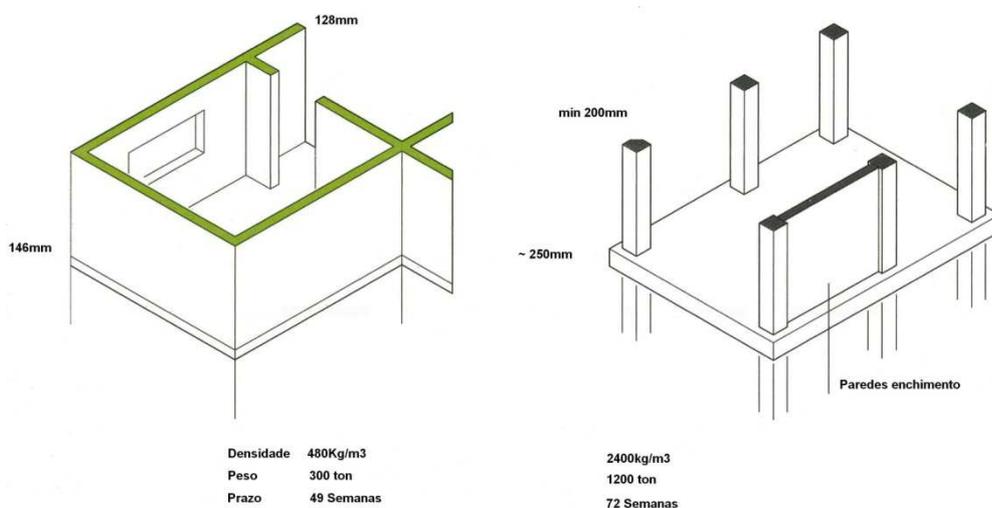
Comparação entre construção em CLT e Betão Armado [17]
